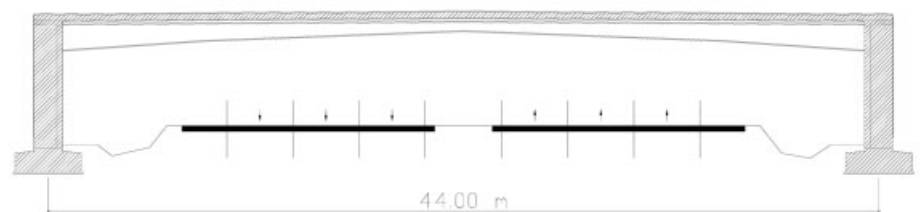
Ü-Bauwerk: Rahmenbrücke als Stahlverbundkonstruktion
